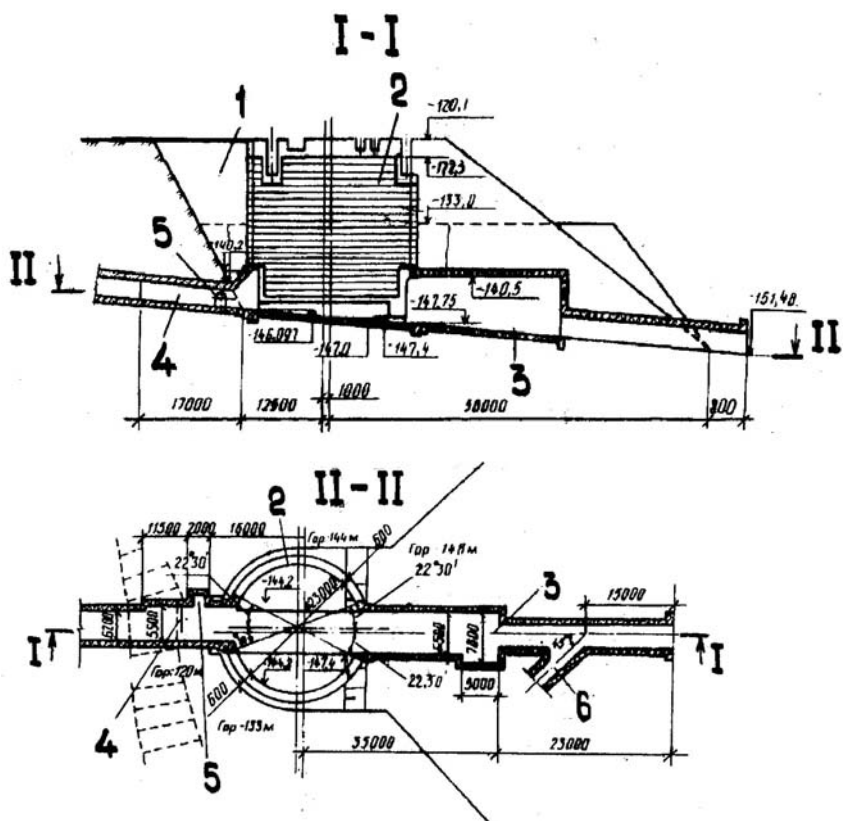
Схема зведення колодязя для дробарки ККД-1500/180 на площадці перевантажувального пункту з кріпленням тьобінгами: 1 – засипувана ділянка котловану; 2 – залізобетонні тьобінги; 3 – камера привідної станції конвеєра; 4 – посадочна площадка; 5 – камера для схову людей; 6 – збійка; I – вісь ствола колодязя; II – вісь ствола дробарки
